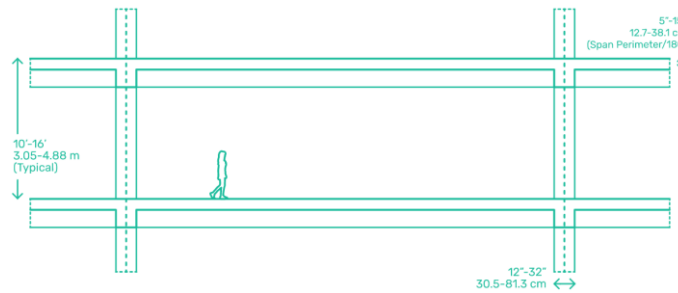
Sistem Konstruksi Rangka Beton Pre-cast
